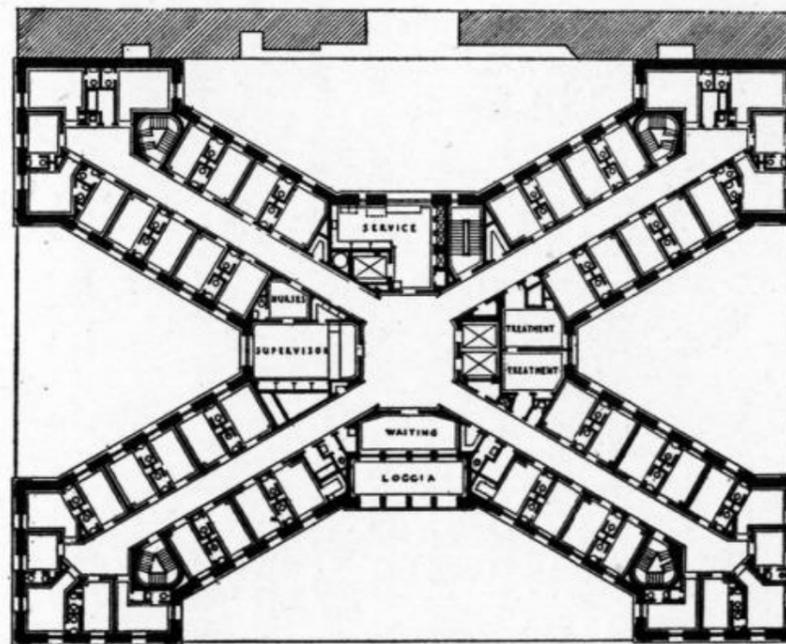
Planta del piso 4 del Hospital de la Quinta Avenida
